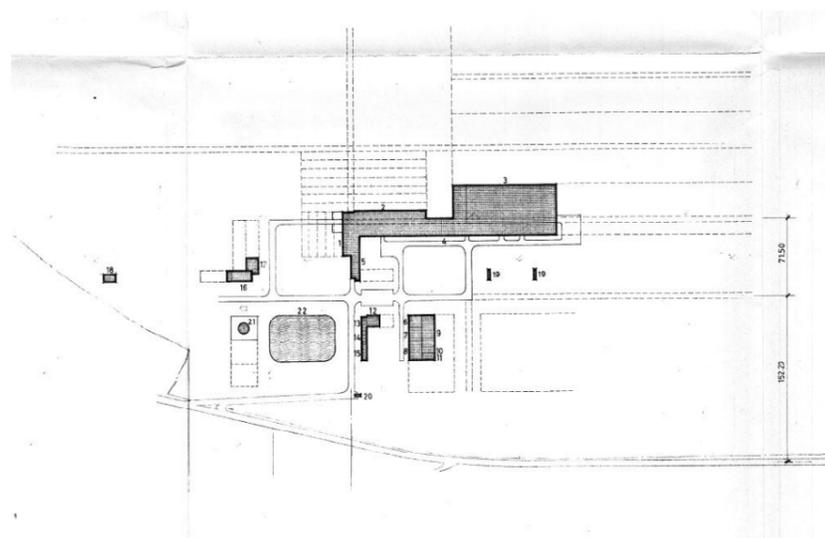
Disposición en planta de Perlofil en 1963, escala 1:2500
